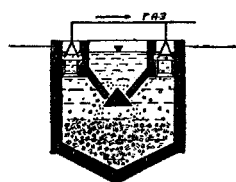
Эмшерский бассейн с приспособлением для улавливания светильного газа из «газовых отдушин».
